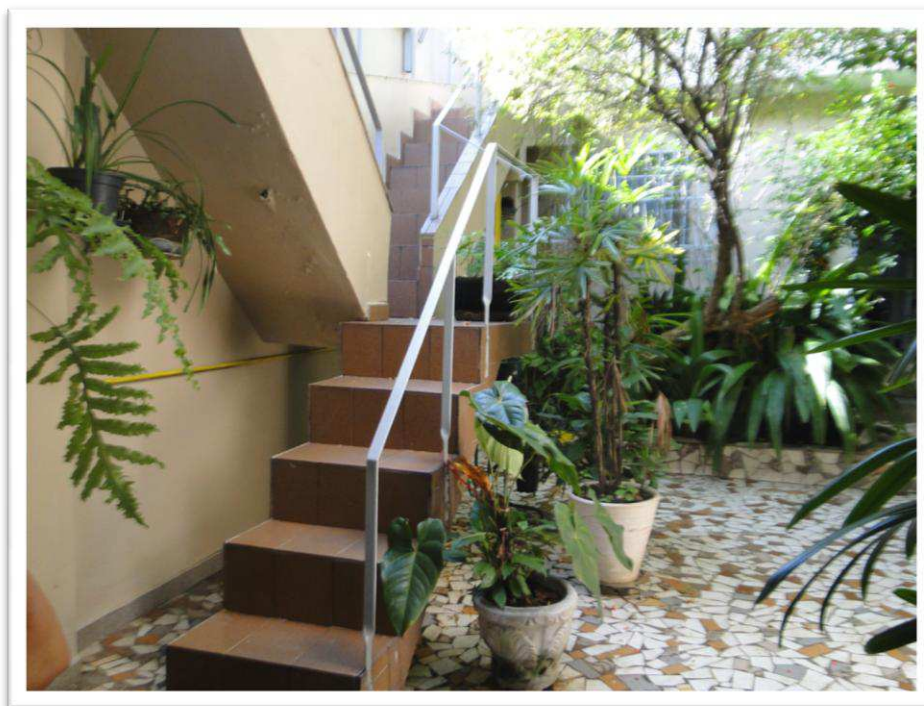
Vista mais detalhada da escada de acesso a laje do pavimento superior.
